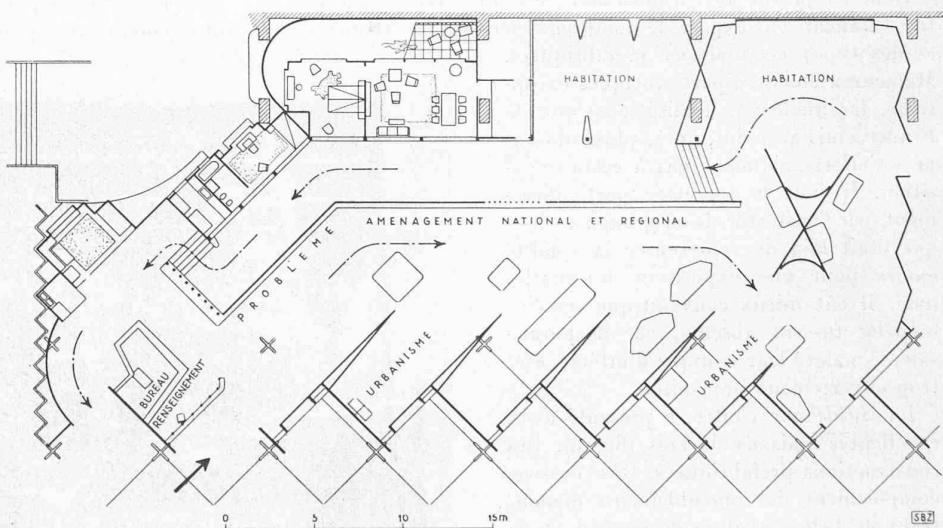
Plan de la section suisse. J. Tschumi, architecte.
